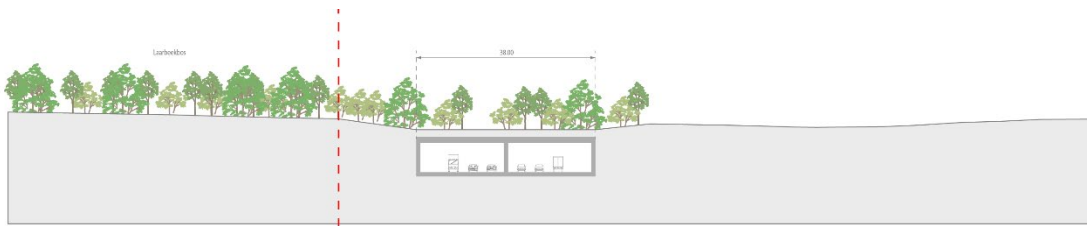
Coupe conceptuelle alternative light G1A1 à la hauteur du pont illustré à l'est
